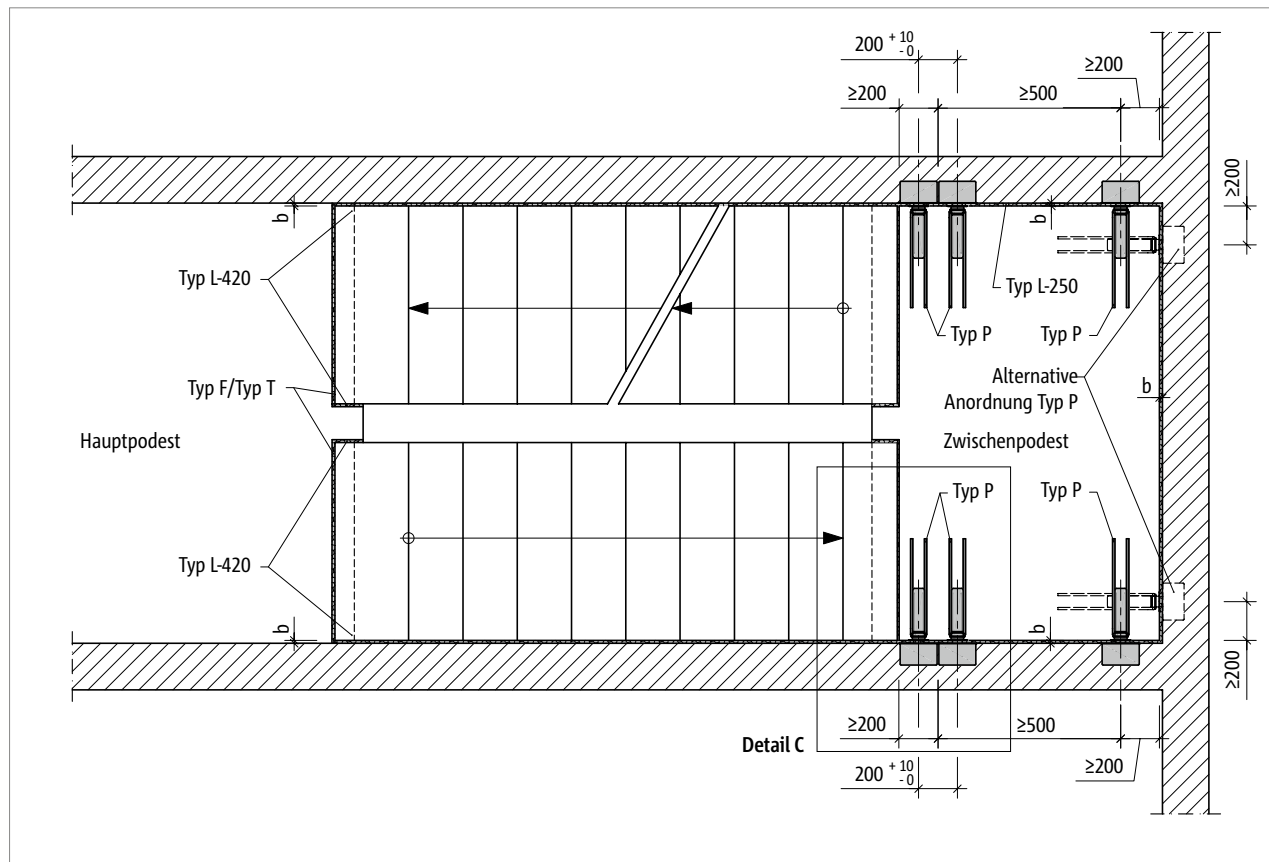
Tronsole® P: Elementanordnung im Grundriss mit Verwendung der Tronsole® L
